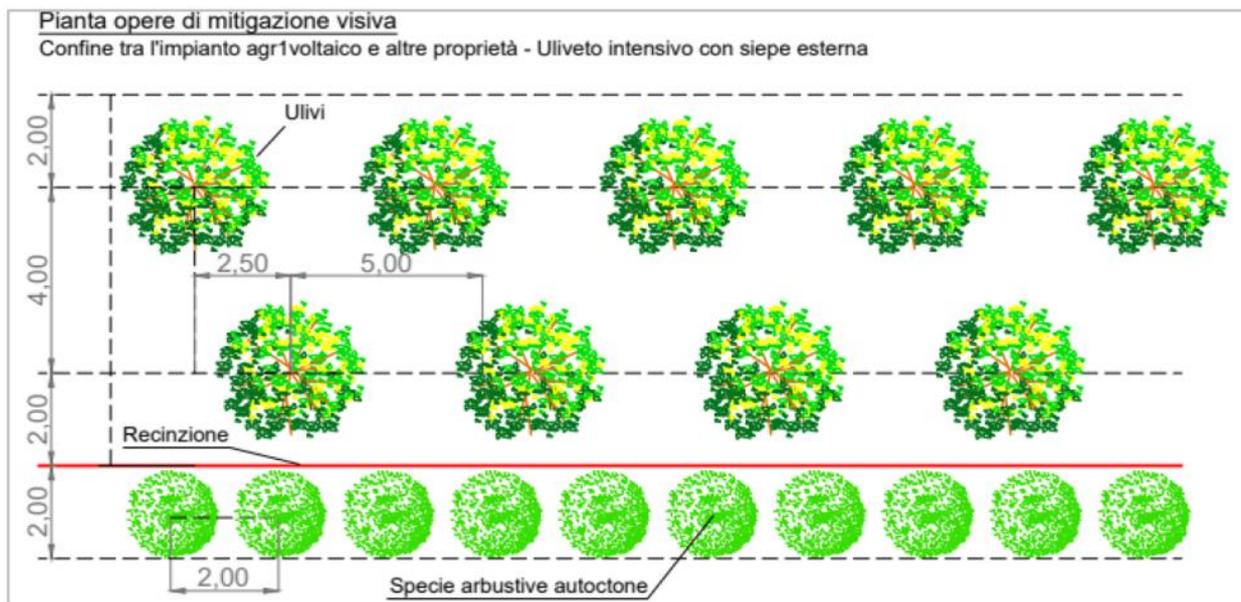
Disposizione sesto piante di ulivo sulle fasce perimetrali
